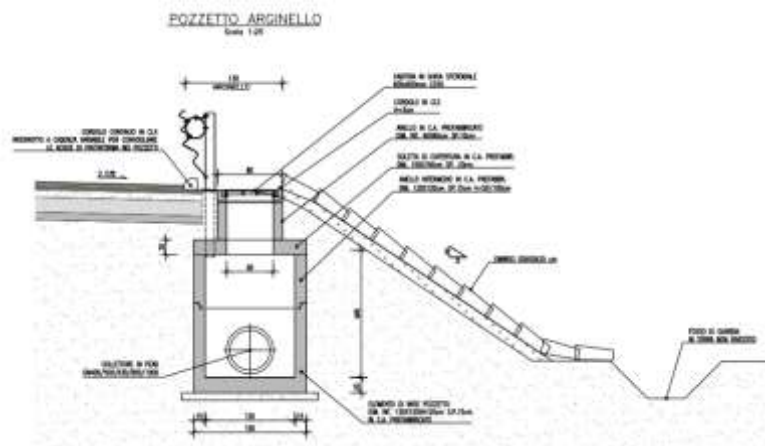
Estratto dalla tavola di progetto dei particolari stradali con indicazione della sezione del pozzetto arginello.
